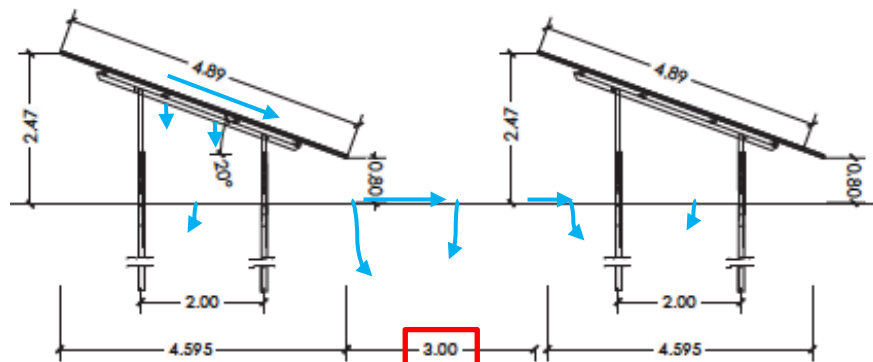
Plan projet Hautes-Forêts (source : dossier de demande de permis de construire, Enertrag)
